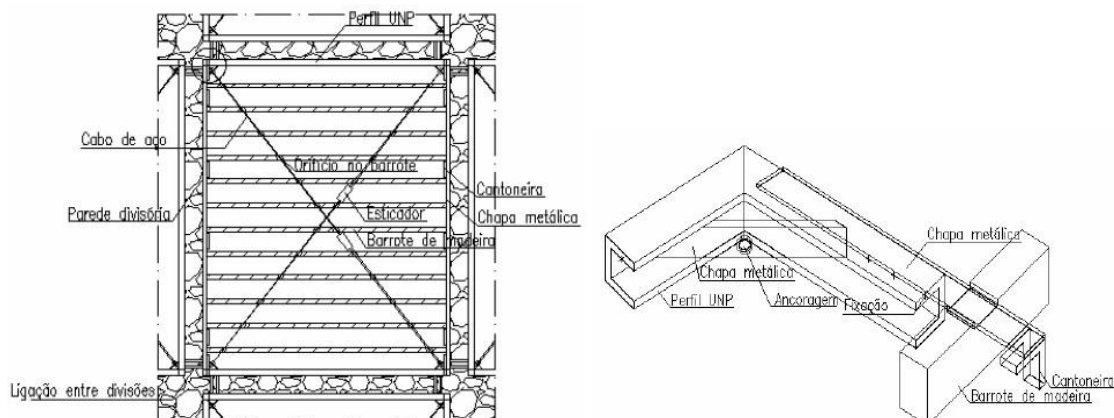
Reforço do pavimento com tirantes (à esquerda) e pormenor de ligação nos cantos das divisões (Branco;2007).
